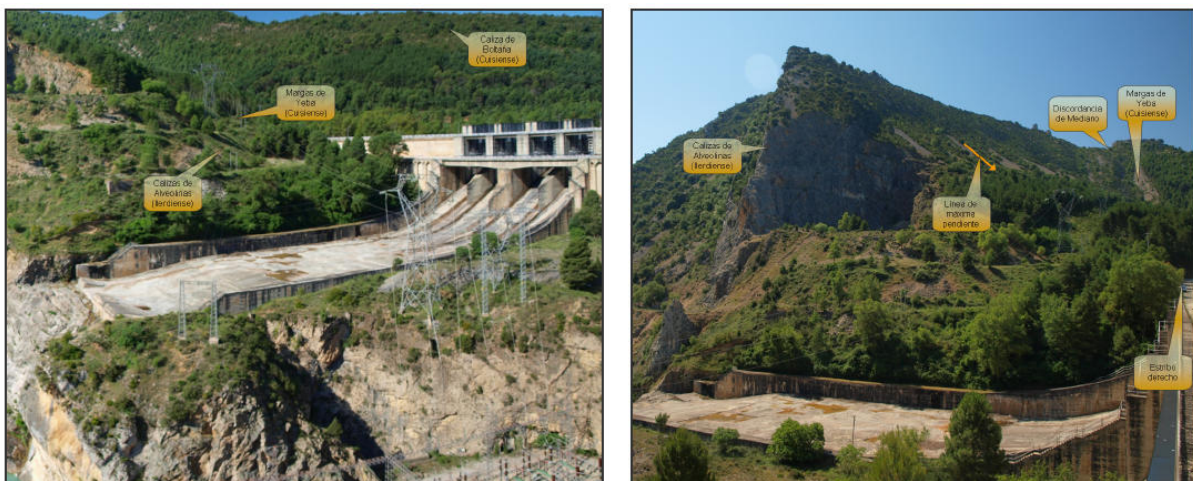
Detalles del apoyo del estribo derecho de la Presa de Mediano
